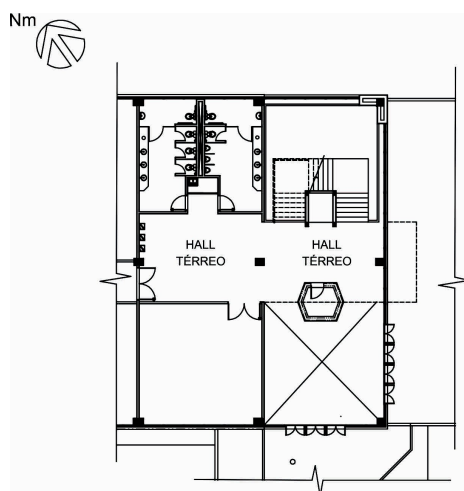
Planta Baixa (Pavimento Térreo) do Bloco Educacional da FIOCRUZ - Brasília/DF, em destaque o ambiente da Recepção.
